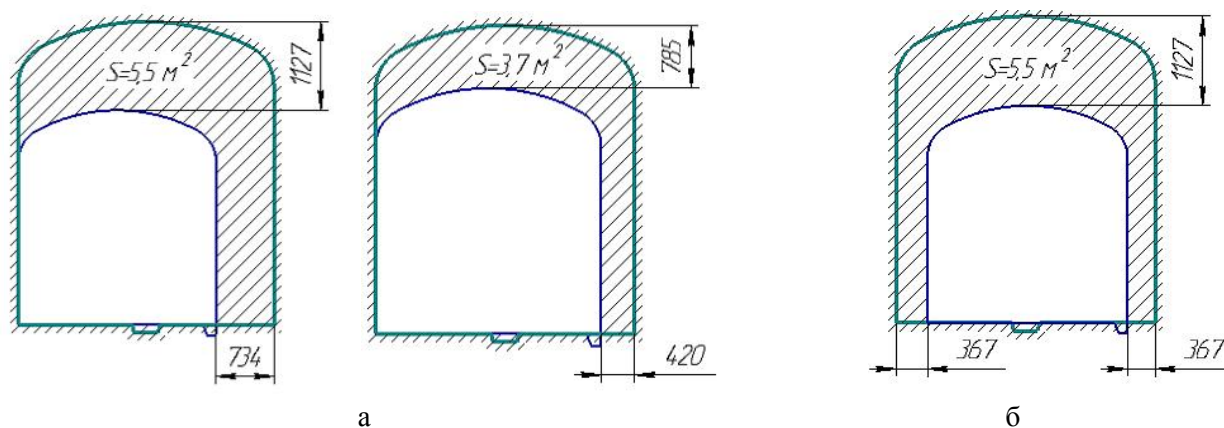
Поперечное сечение выработок с учетом расширения сечения: а – одной стенки и свода; б – двух стенок и свода
